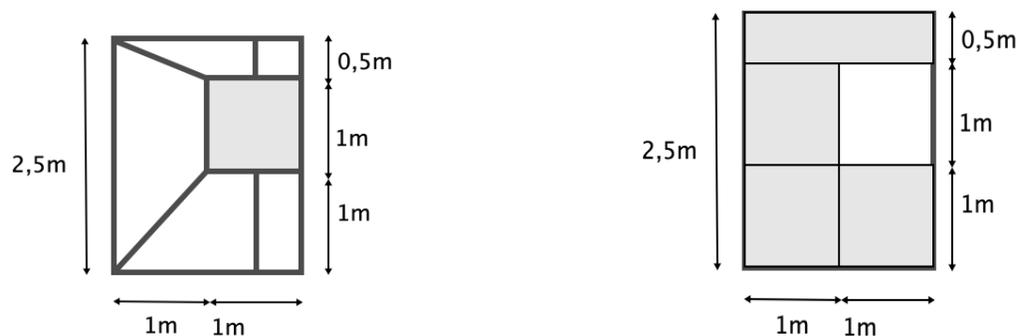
Panel ventana estructural vista interna (izq) y vista externa (der)
